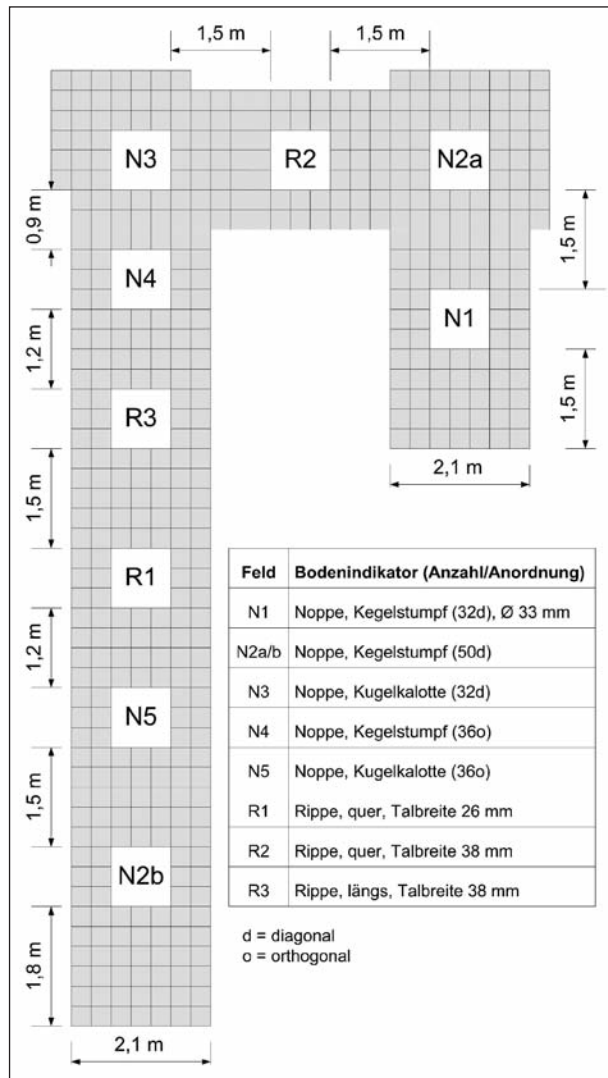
Teststrecke mit Bodenindikatoren – Grundriss
